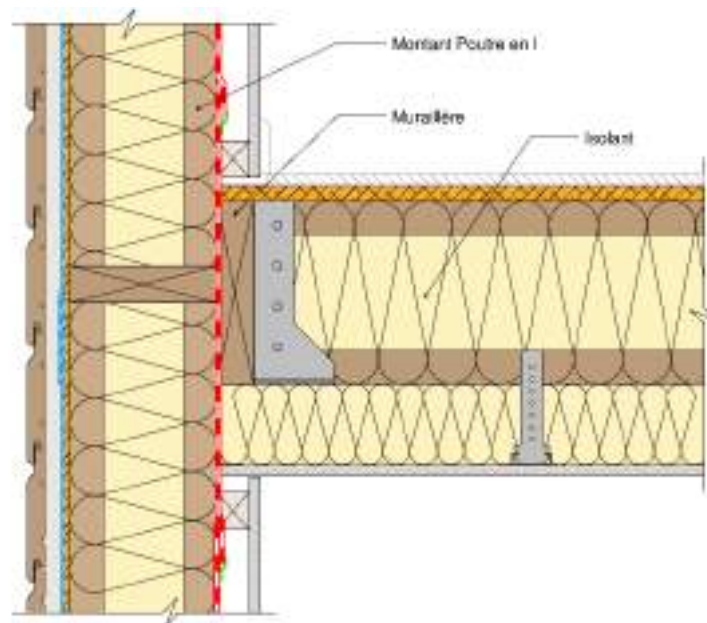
Liaison mur extérieur / plancher intermédiaire en technique balloon-frame (mur filant)
